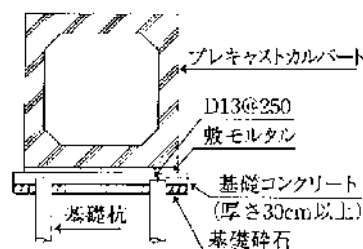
プレキャストコンクリート暗きよの杭基礎
